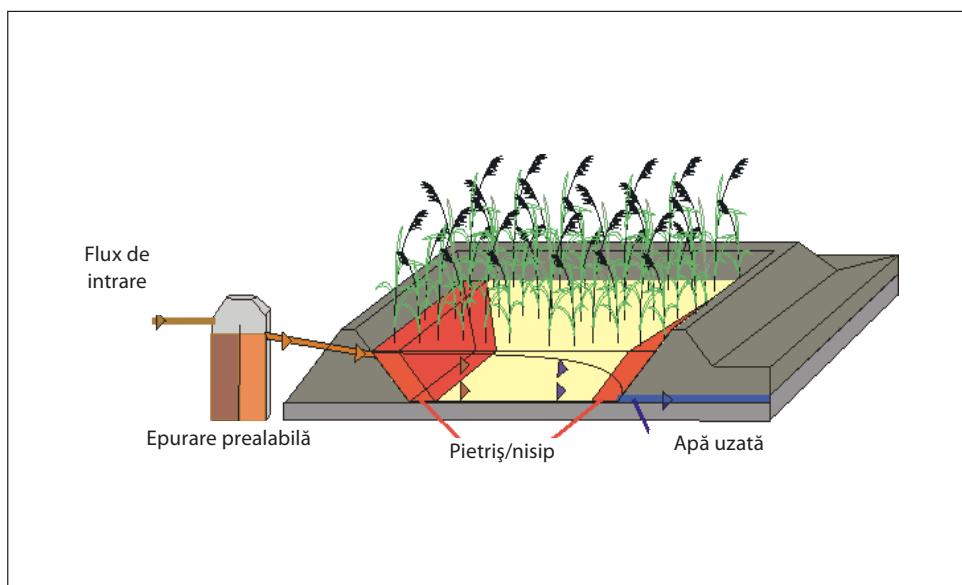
Zonă umedă construită cu scurgere orizontală cu epurare prealabilă (sursa: www.bodenfilter.de)
